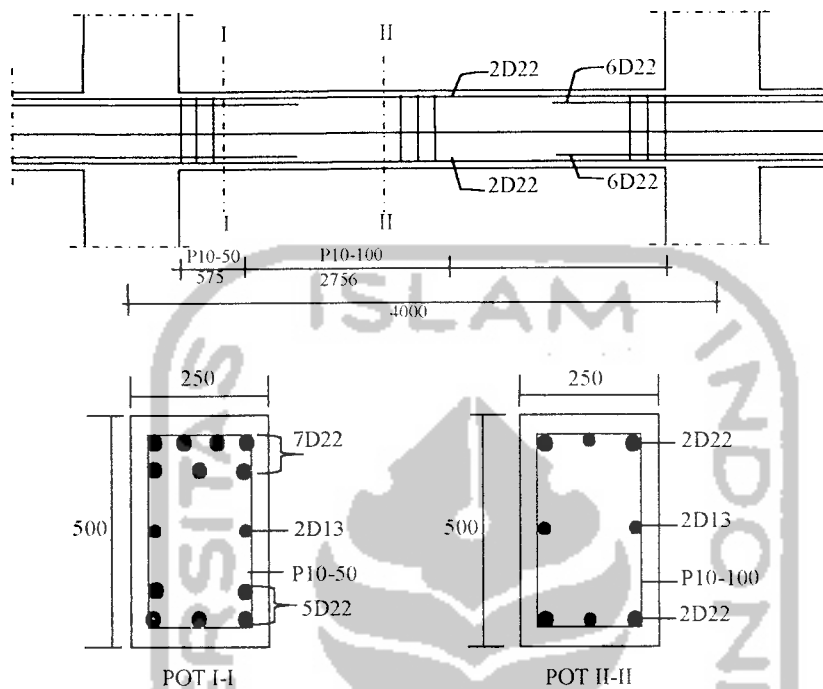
Balok Portal E Bentang 4 m Lantai 3
